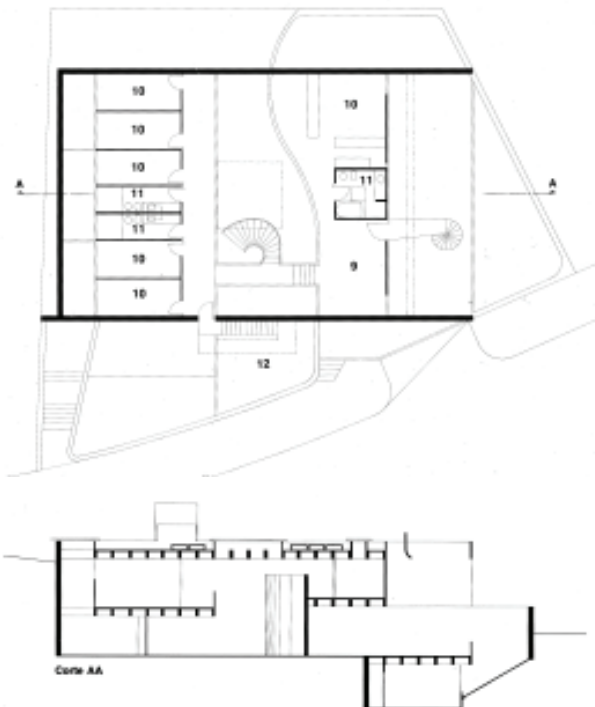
Residência Milan – Planta do pavimento superior e corte
